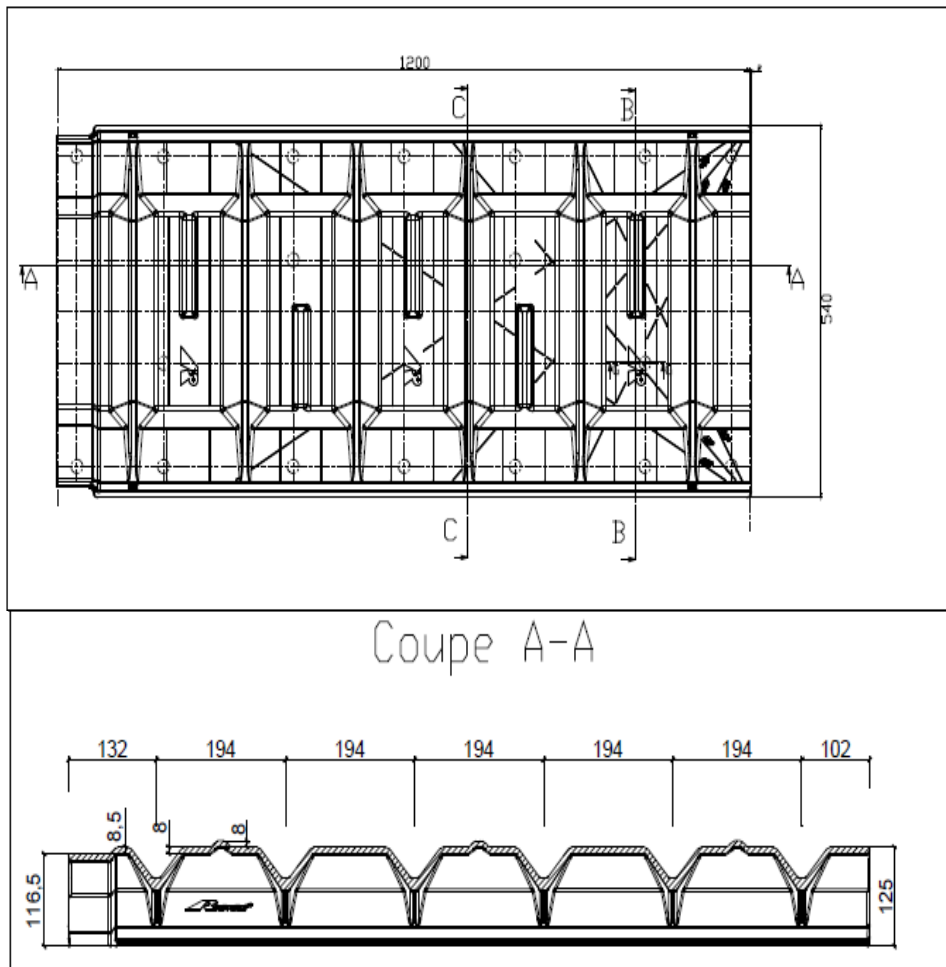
Entrevous Fabribois ou Duranlight (longueur 1200 mm) hauteur coffrante 160 mm
